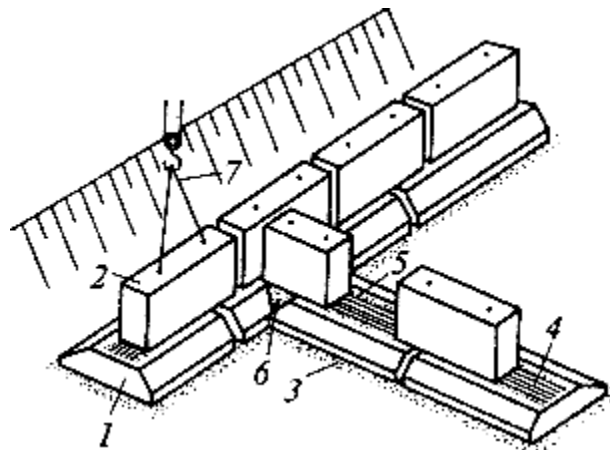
Монтаж сборных ленточных фундаментов
